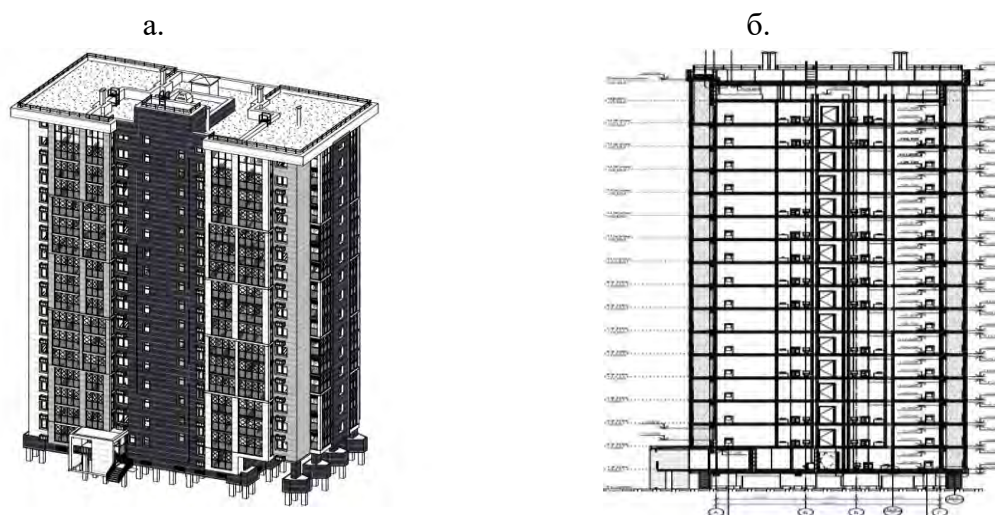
Одноподъездное 16-ти этажное каркасно-монолитное здание: а - 3D вид; б – вертикальный разрез
